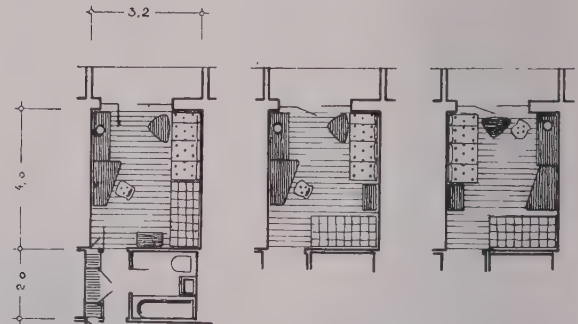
Einbett-Zimmer, Typ „Ferienhotel“ 1 : 200
